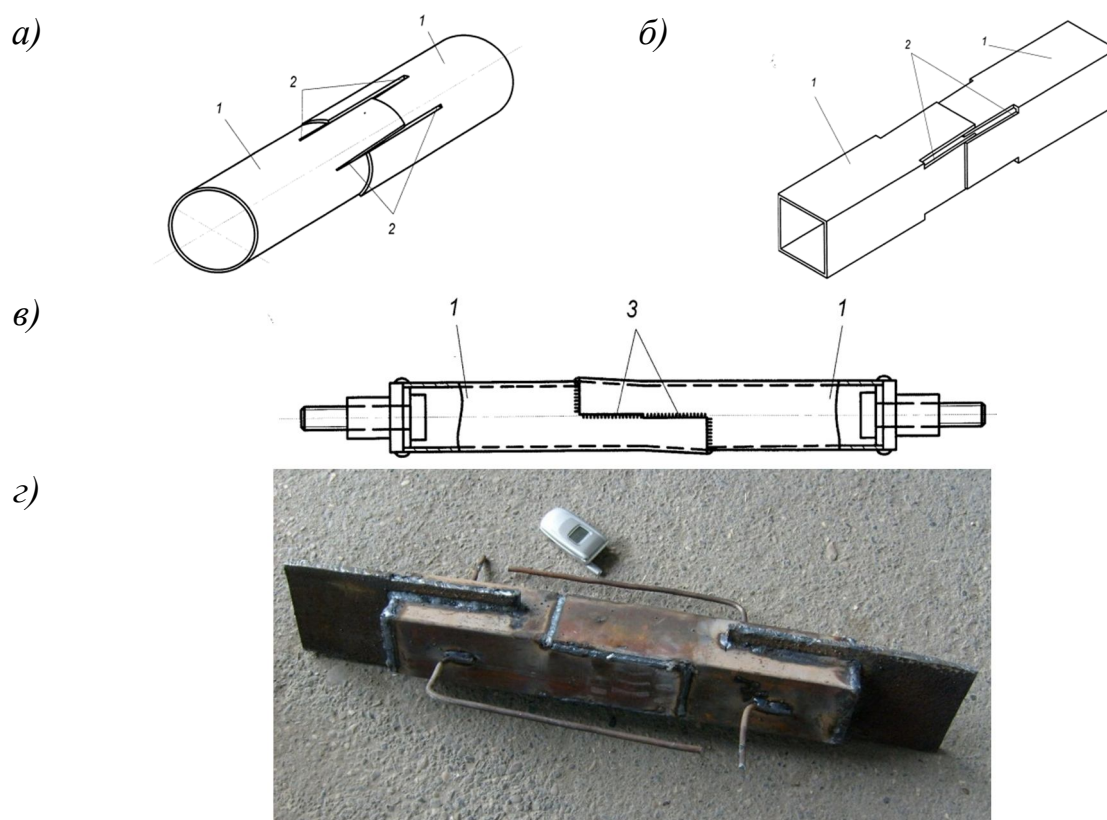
Схемы стыковых сварных соединений: *а* – стержневых элементов из круглых труб; *б* – стержневых элементов из прямоугольных (квадратных) труб; *в* – стержневых элементов из унифицированного сортамента структурных конструкций системы «МАрхИ», «Кисловодск», модернизированных для повторного применения; *г* – снимок опытного образца из квадратных труб сечением $\square 80 \times 80 \times 3$ мм до его испытания на разрыв; 1 – стержневые элементы; 2 – продольные прорези; 3 – сварные швы
